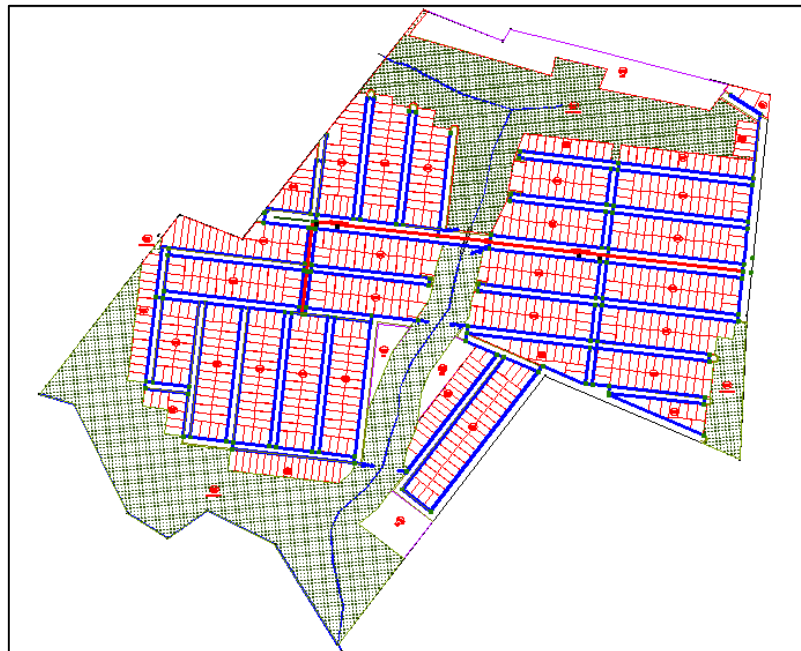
Planta baixa do loteamento Green Park e do sistema de abastecimento de água.
